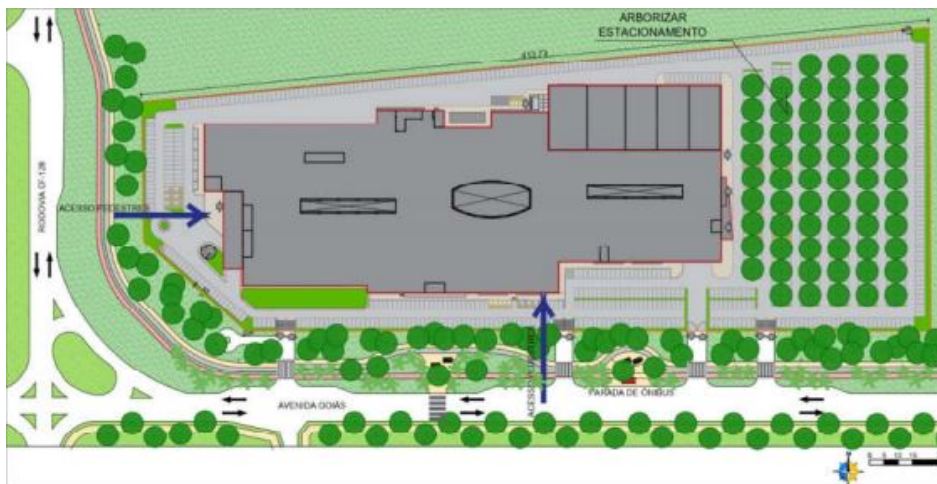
croqui esquemático de Indicação para parte das medidas de adequação do Estudo Preliminar de Arquitetura. Fonte: EIV
